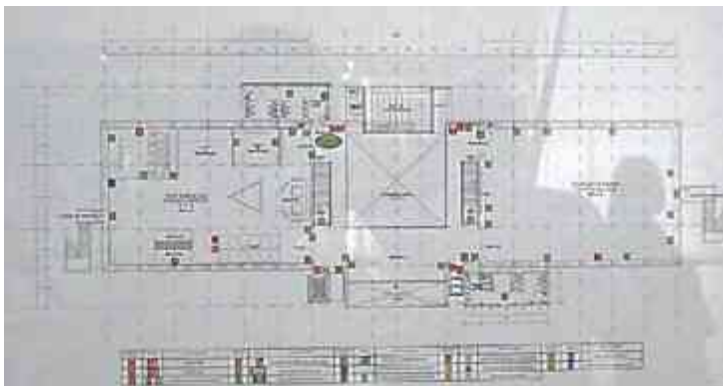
Plano arquitectónico de la planta alta del MUTECH
